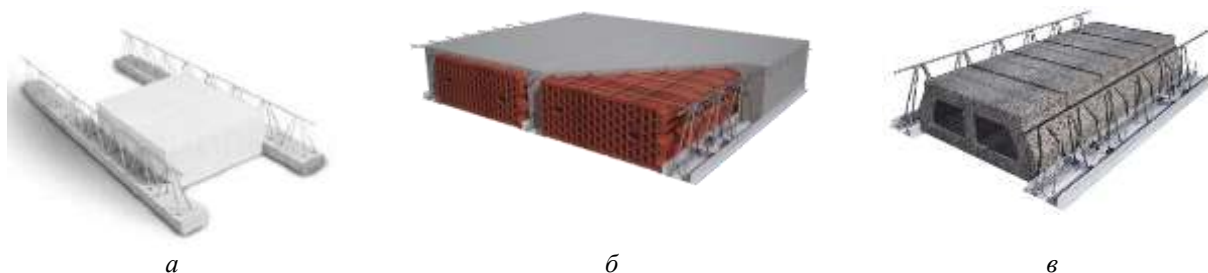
Варианты исполнения сборно-монолитного перекрытия:
